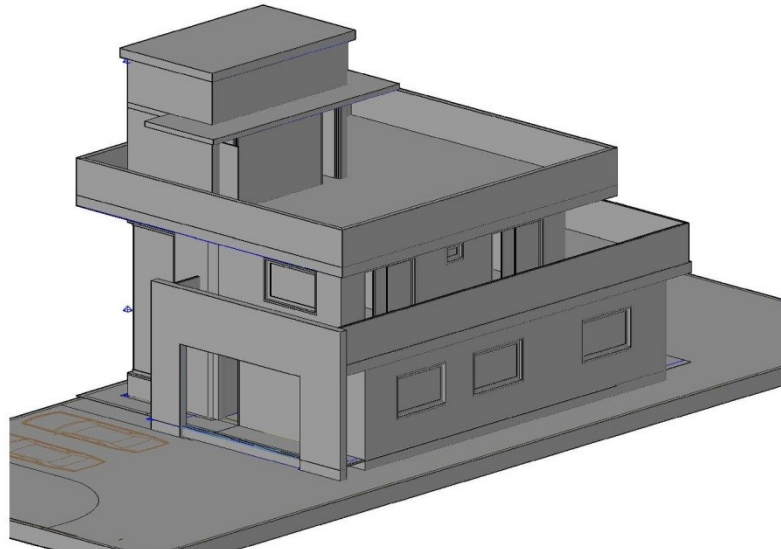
Projeto arquitetônico: Fachada norte fundos
